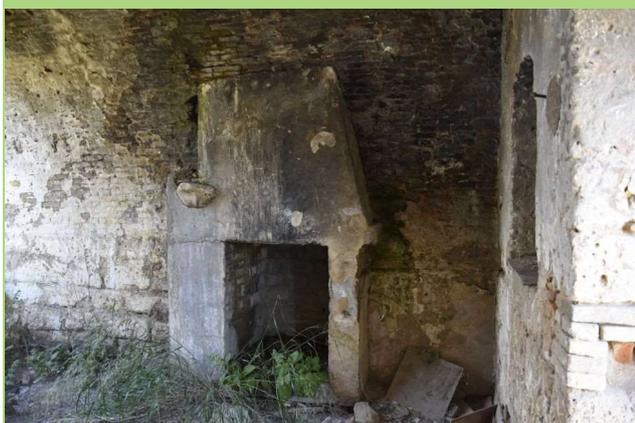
Interno con vecchio caminetto dell'abitazione precedente (A.3.a).
